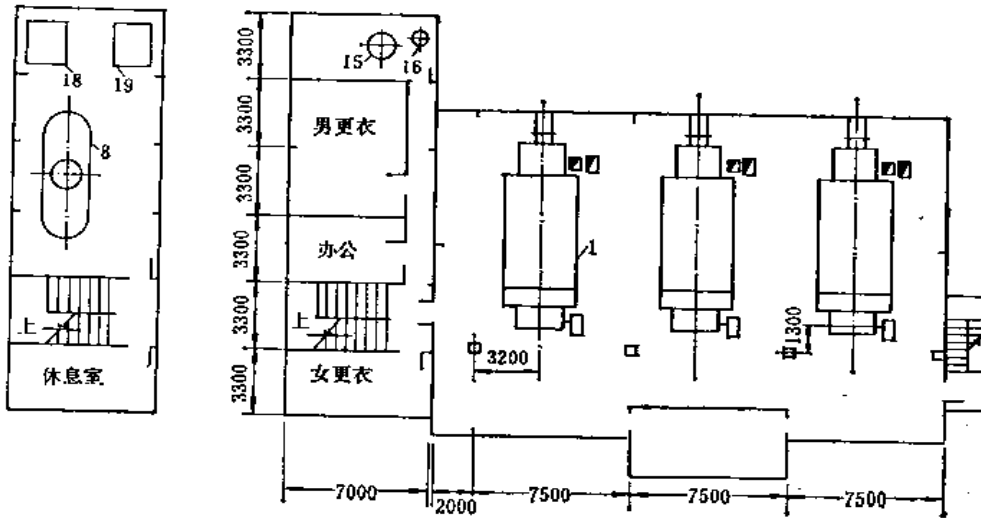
三台QXL600-13/100型锅炉房一层平面图
